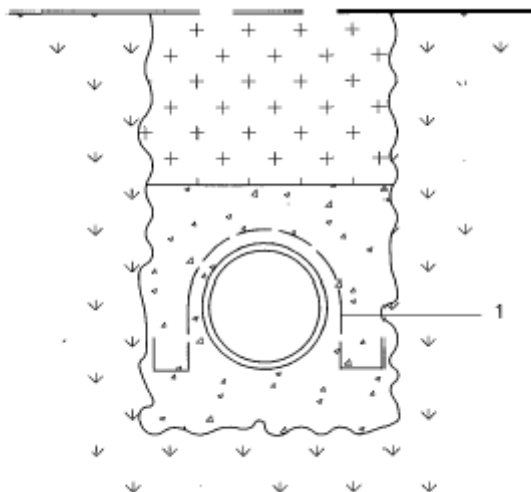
Zabezpieczenie przed migracją cząstek materiału gruntowego
